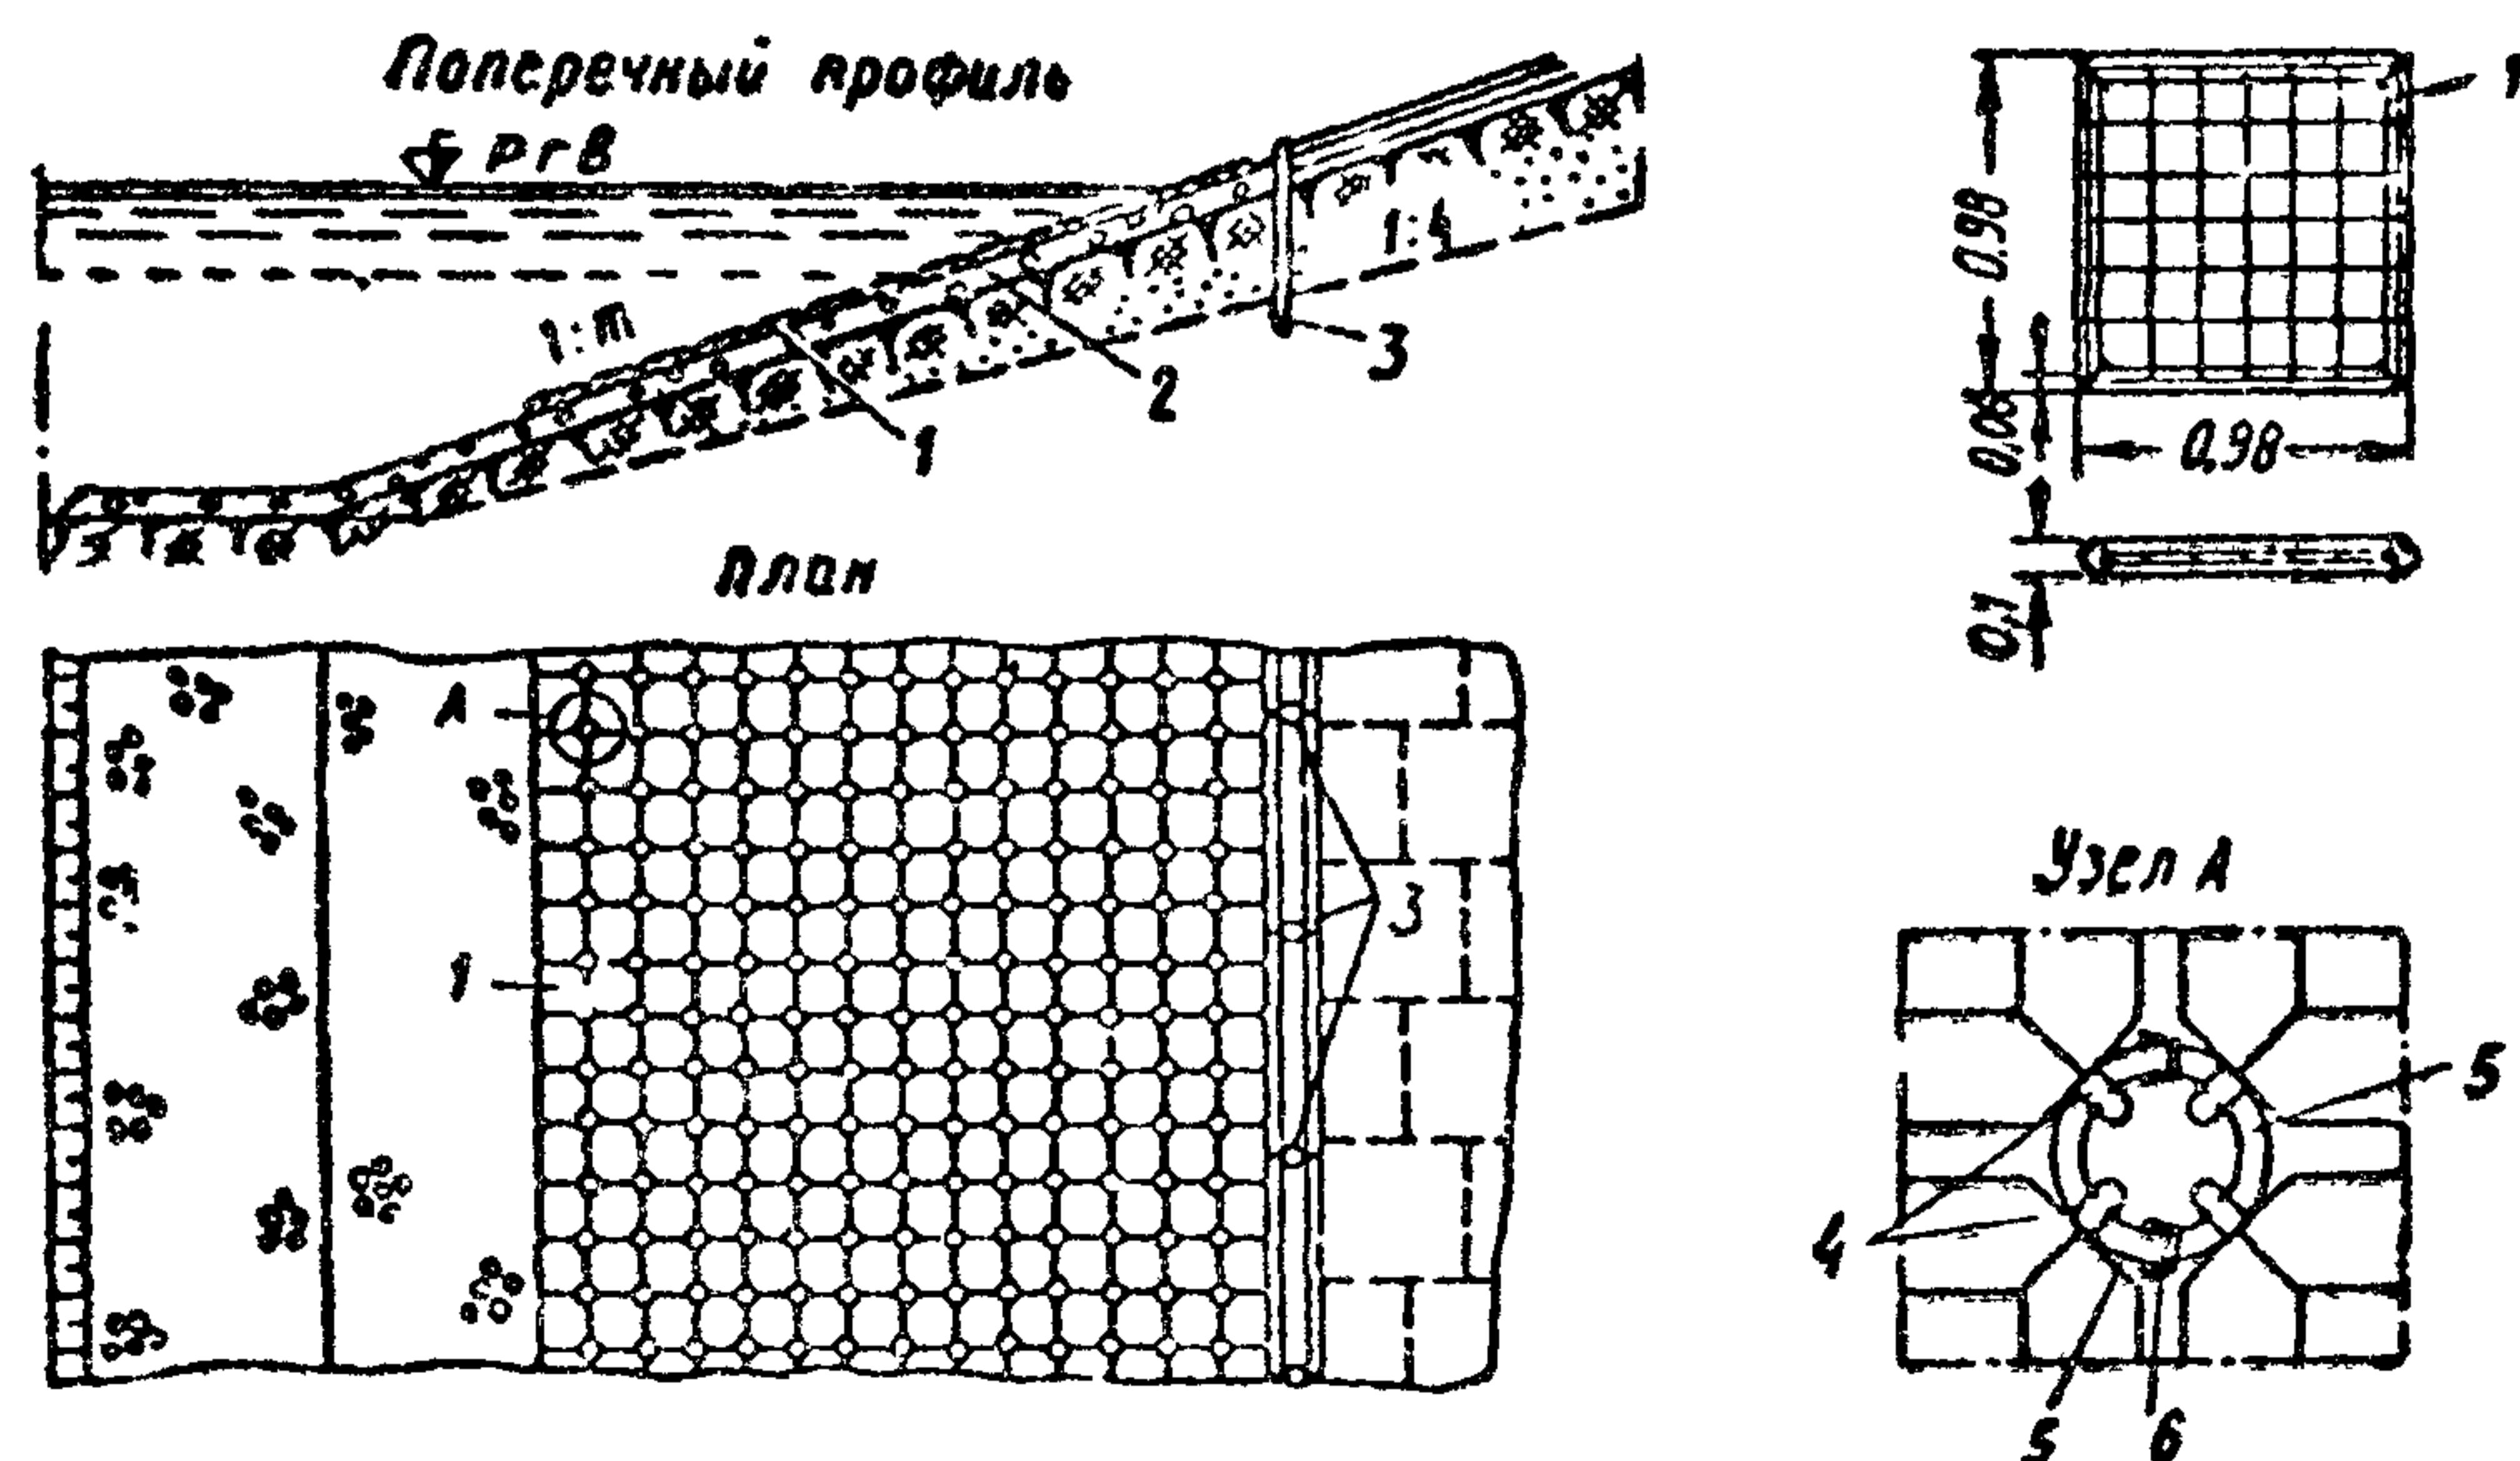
Конструкция крепления откоса гибким тюфяком из железобетонных плит:
